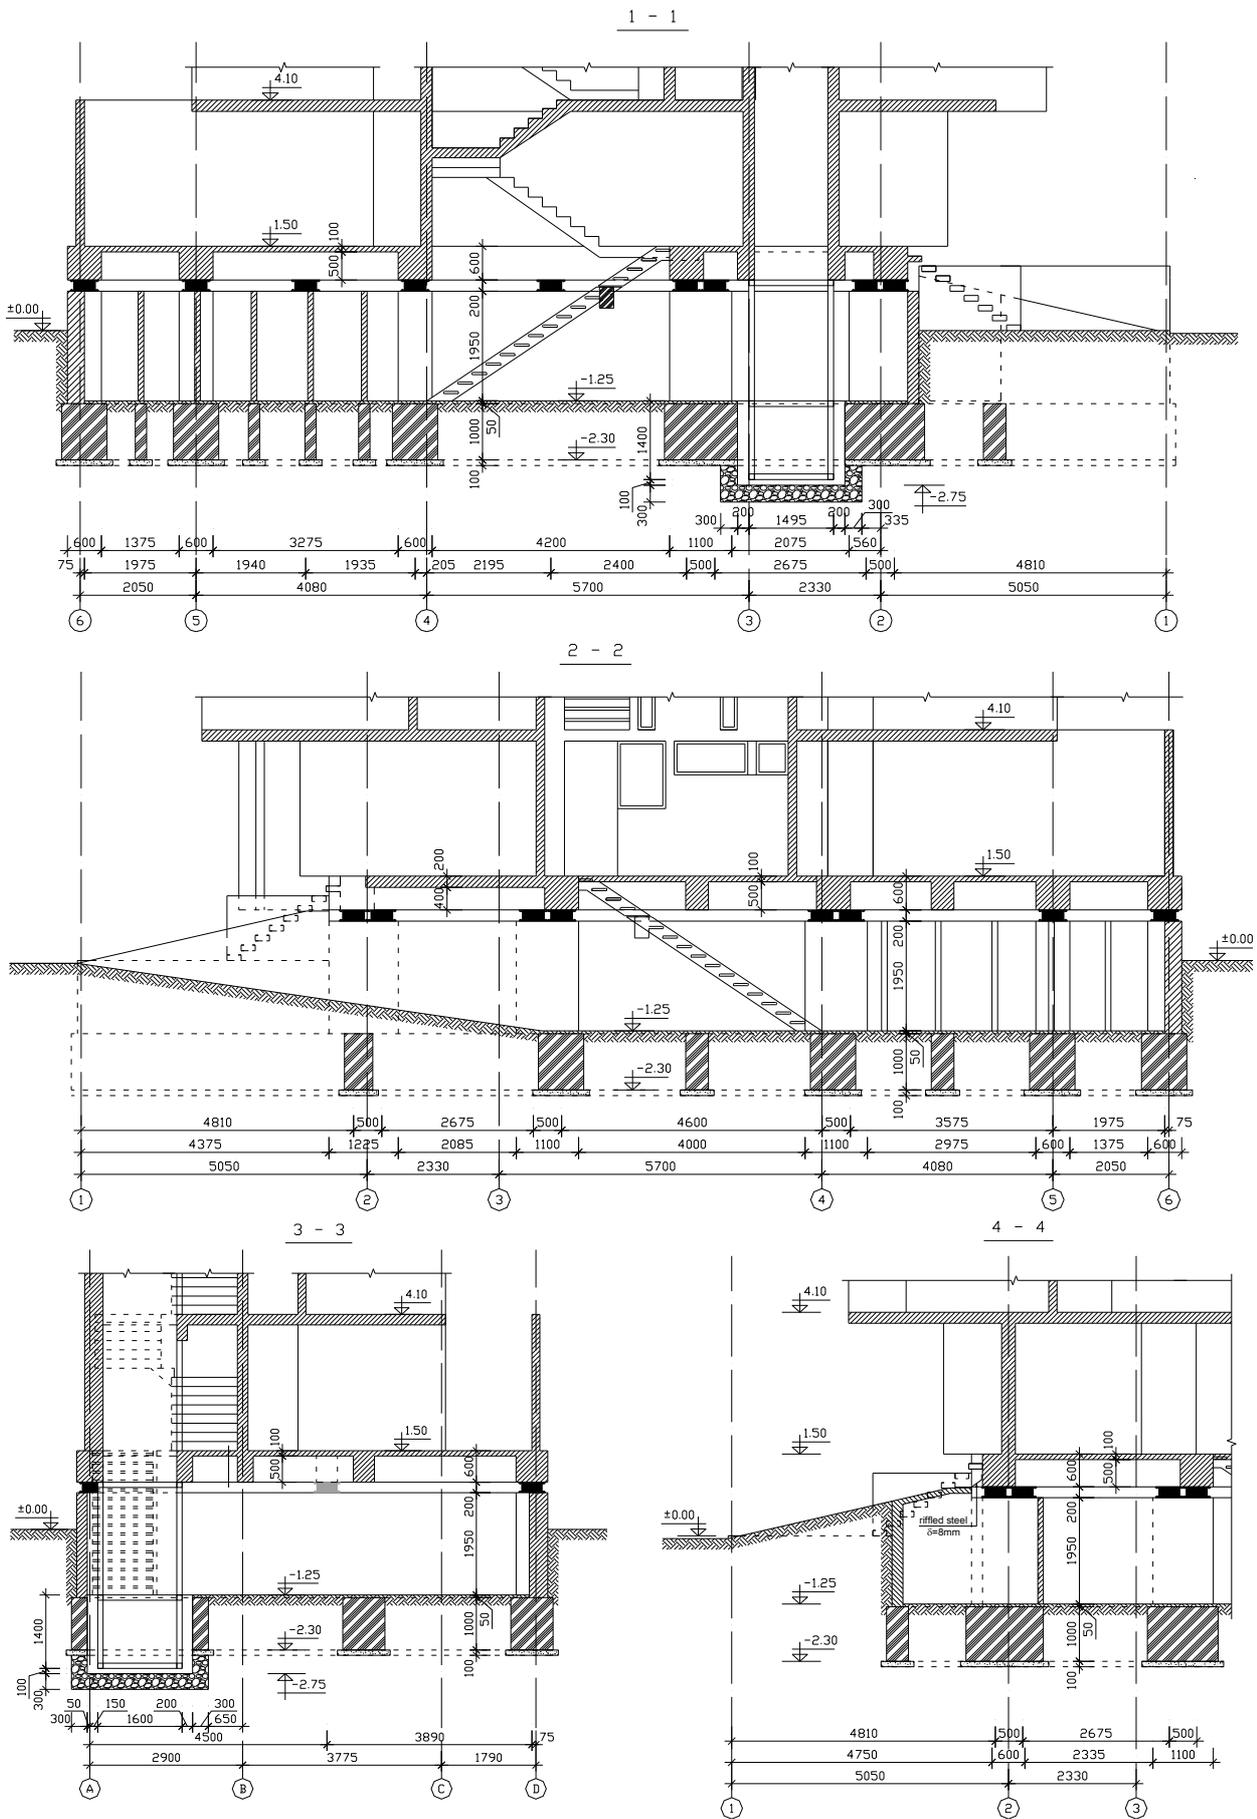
Разрезы жилого сейсмоизолированного здания по ул. Чулло в г. Арекипа
